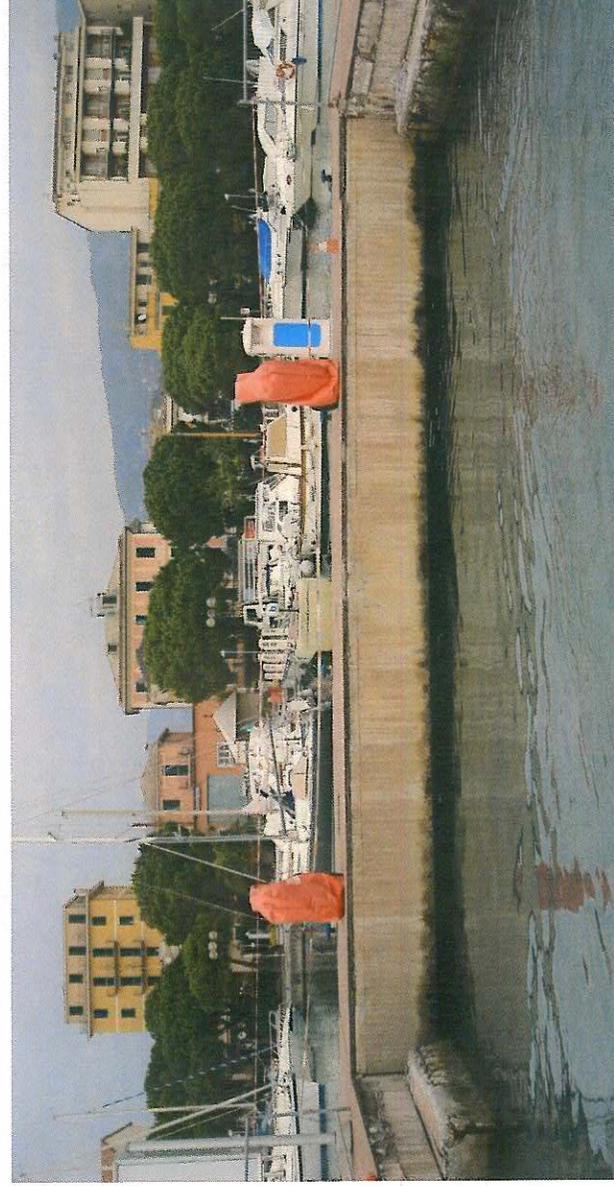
Pontile est. Zona del crollo dell'elemento prefabbricato in cap.
